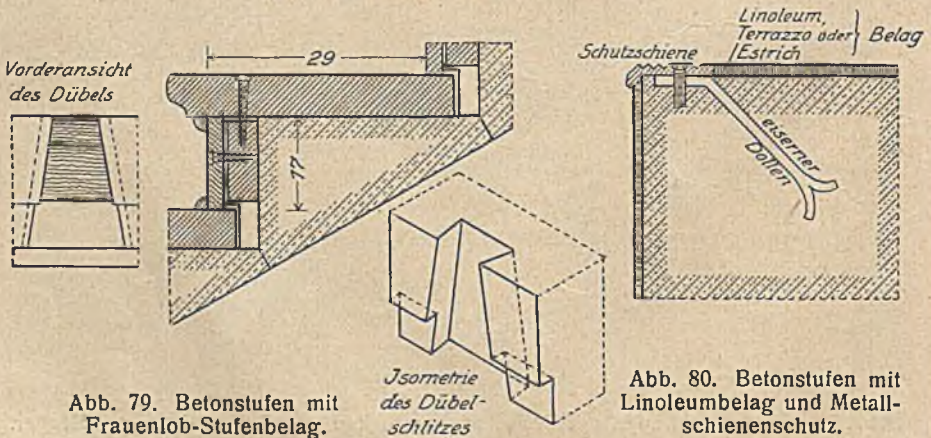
Betonstufen mit Frauenlob-Stufenbelag.
